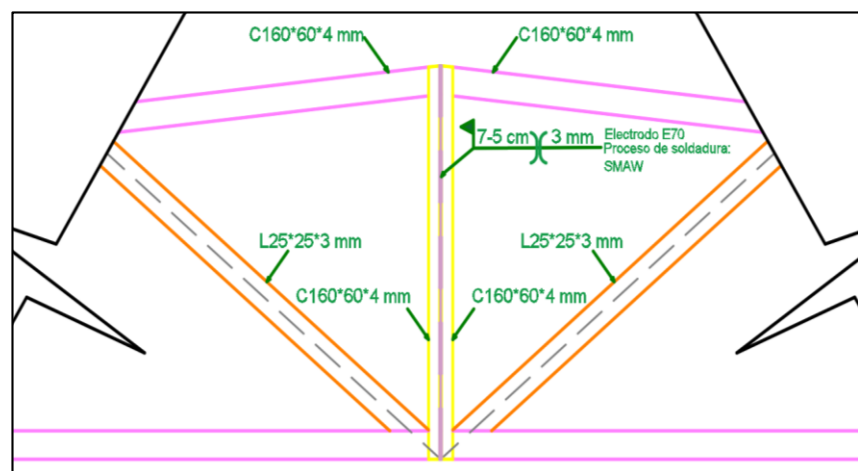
Detalle Soldadura Cumbrera.
